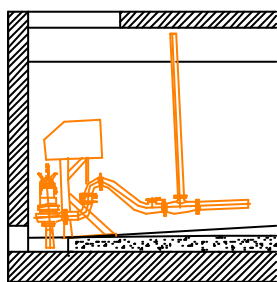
Diseño dispositivo giratorio con accionamiento sumergido
